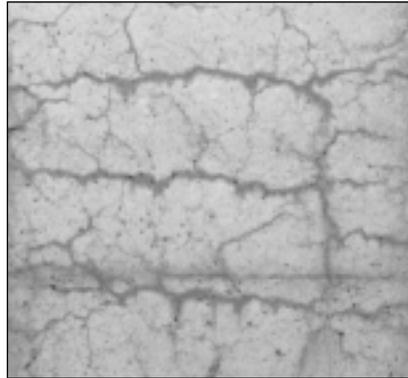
Fissuration importante parallèle aux barres d'armature dans le mur de soutènement d'un pont de la Ville de Québec (Québec)
